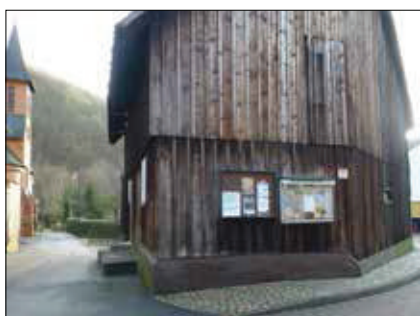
Wohngebäude in eingeschossiger Bauweise
